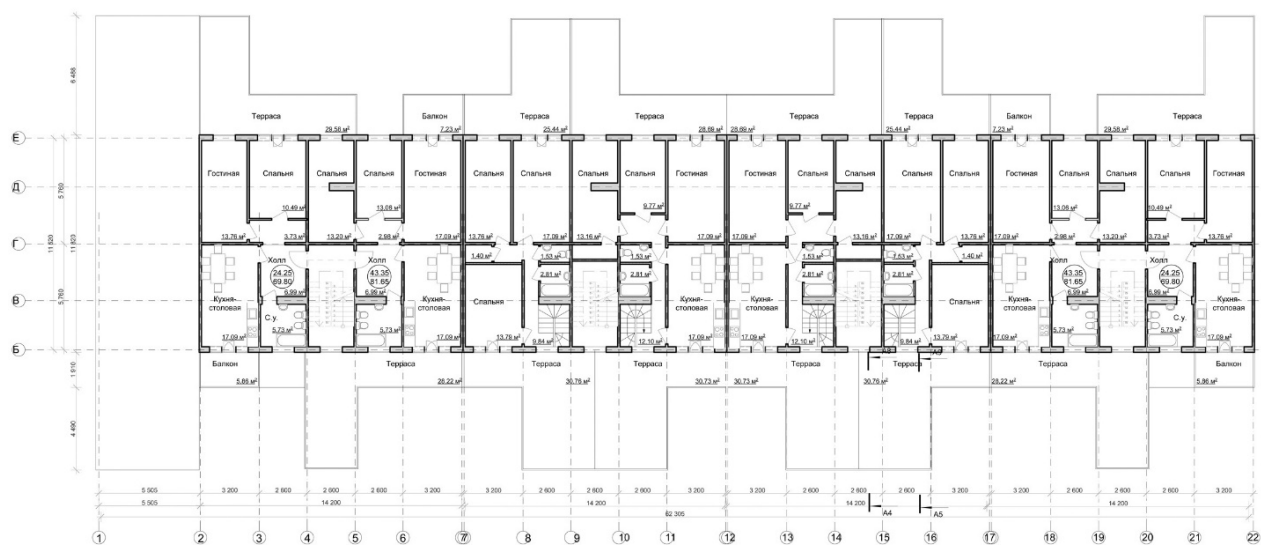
План второго этажа. Реконструкция с переходом от среднеэтажной к малоэтажной застройке
